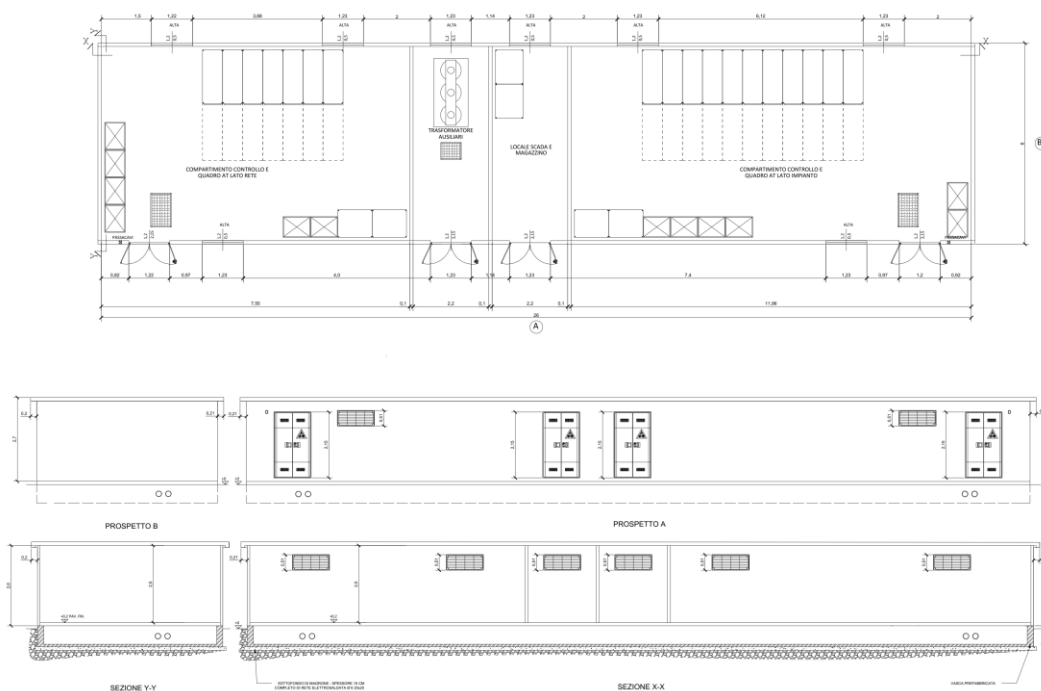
Cabina AT di smistamento - Vista in pianta e prospetto (estratto di PRO_TAV_19)
